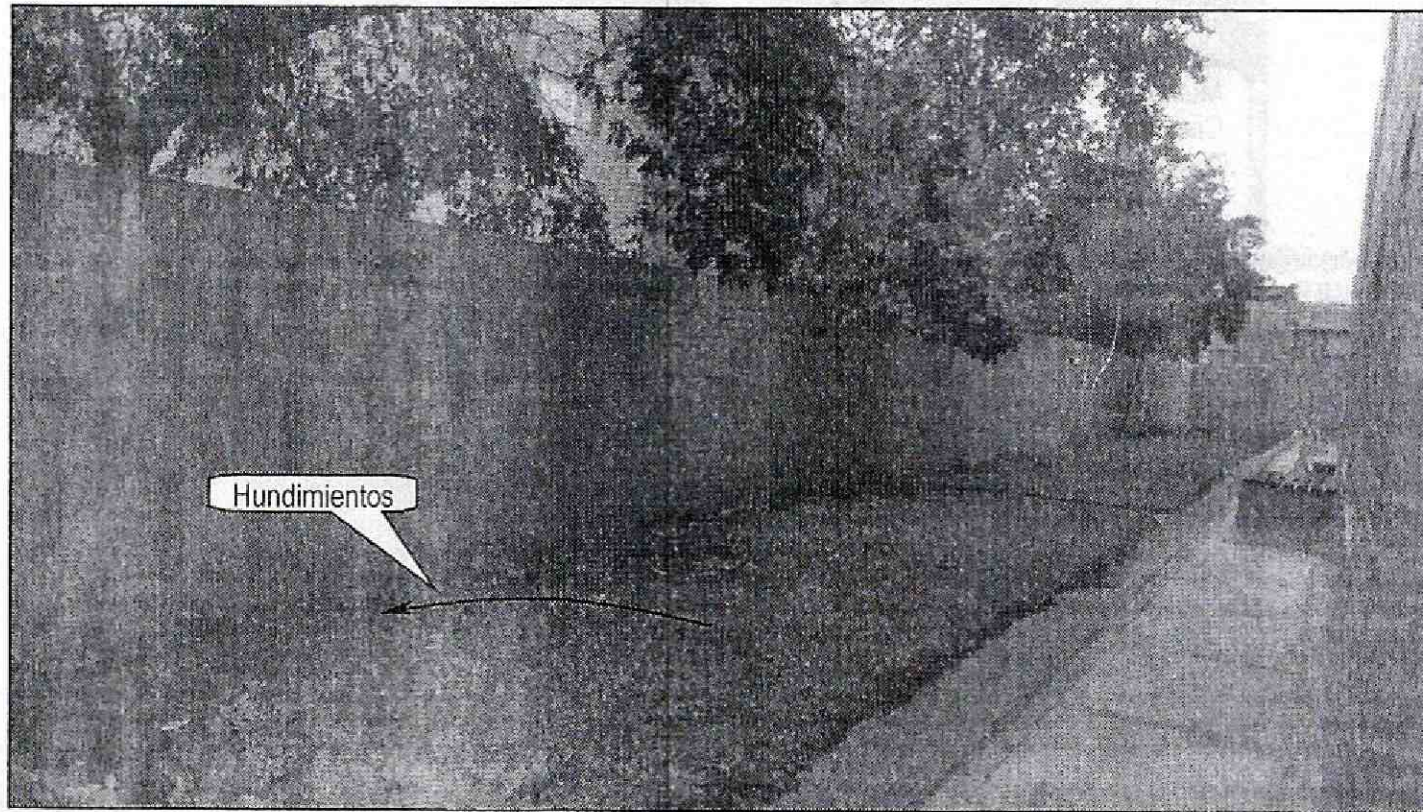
y 4. Vista de las grietas escalonadas en el muro de cerramiento del Conjunto Residencial Torres de Villa Julia de la Calle 169 A No. 62-26 en el Sector Catastral Portales del Norte, de la Localidad de Suba
